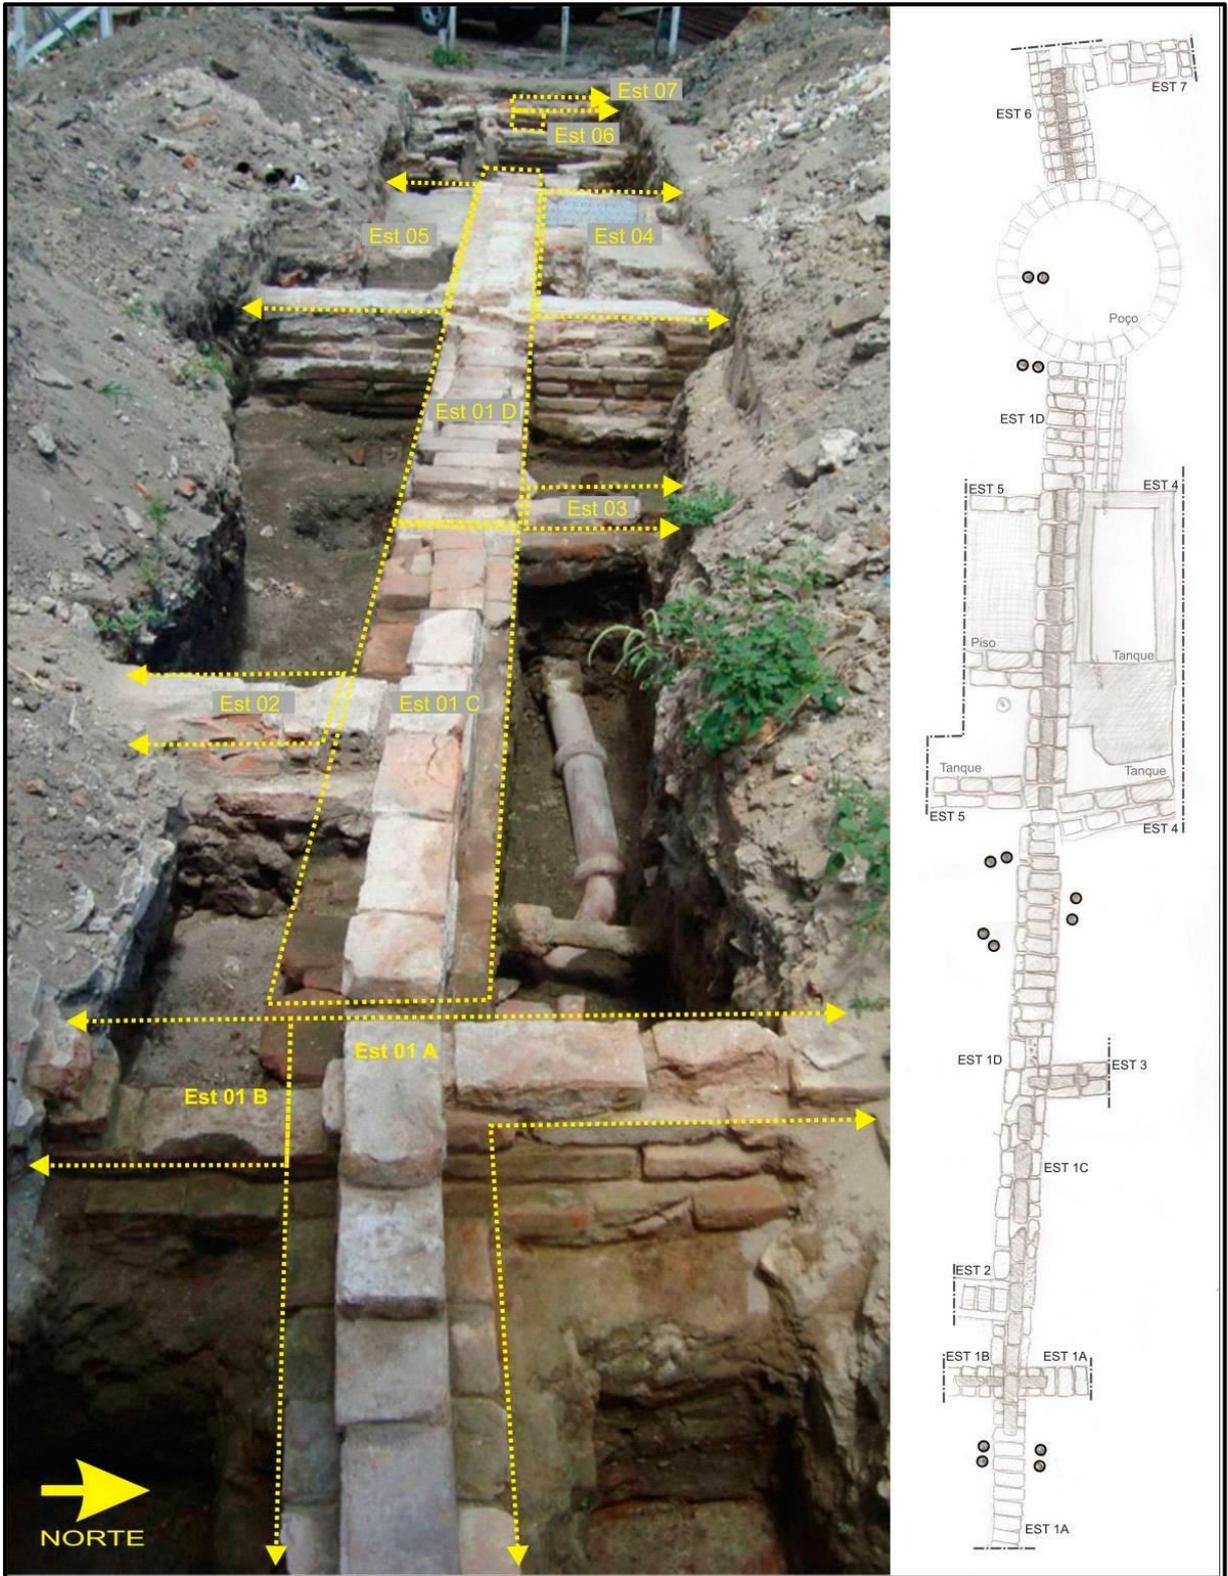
Vista geral do conjunto de estruturas encontradas durante as escavações para implantação dos blocos de pilares 12, 13 e 14 da Quadra 40. Entre as estruturas “6” e “1D” visualiza-se um poço. Fonte: FUNDAÇÃO SERIDÓ, 2011b, p.58.
